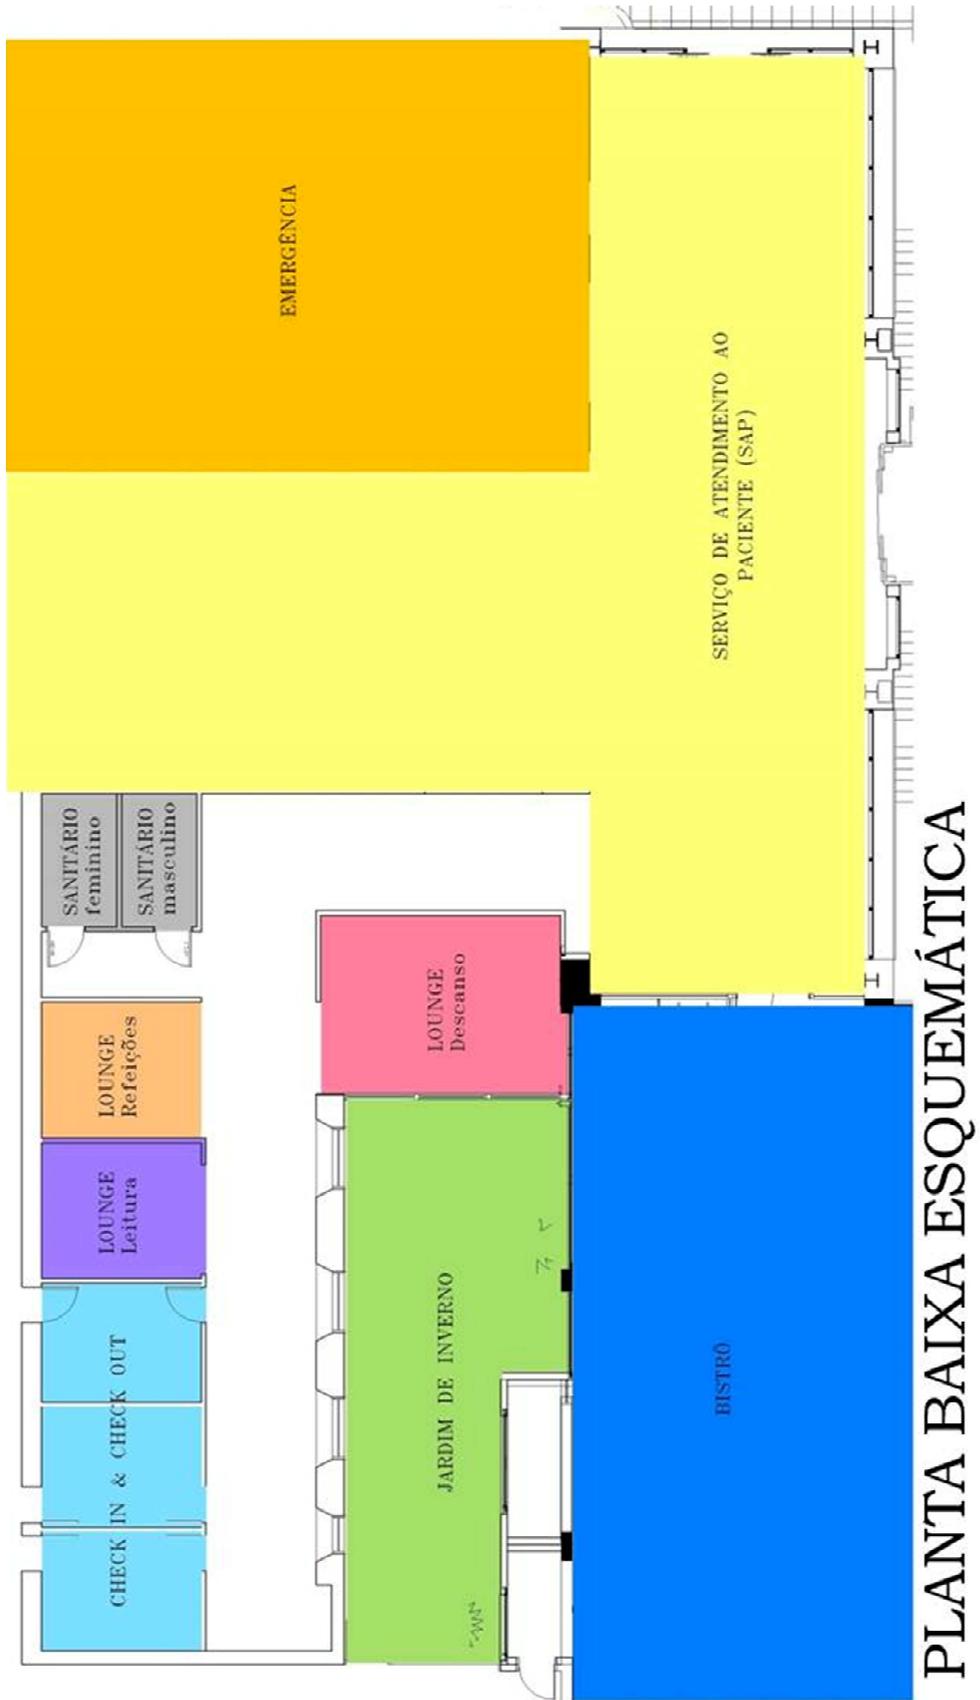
Planta Baixa da Sala do Paciente Internacional
